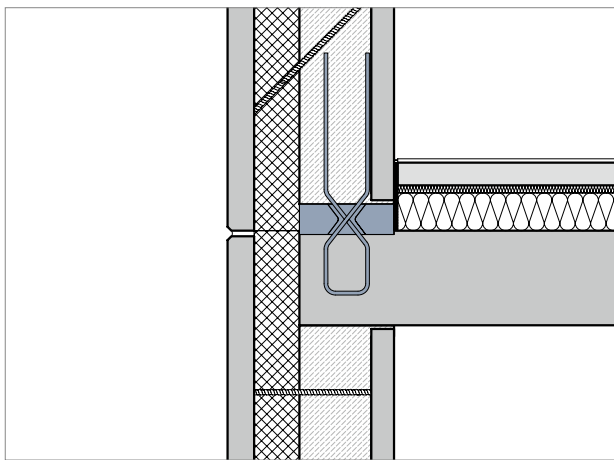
Schematische Darstellung Schöck Sconnex® Typ W bei Elementwänden und Aufdeckendämmung
